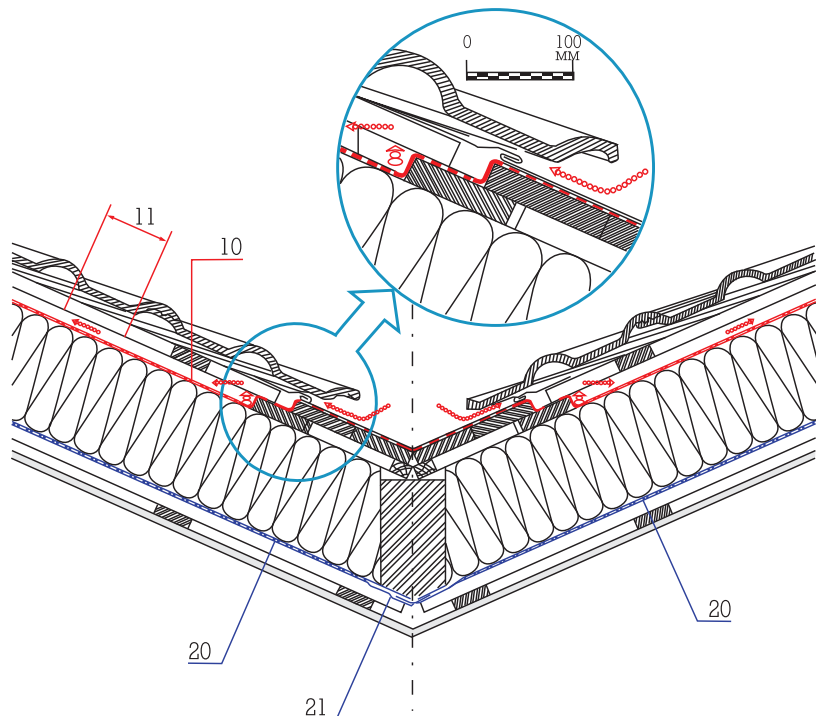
Профессиональное устройство гидроизоляции в ендове. Схемы DORKEN
